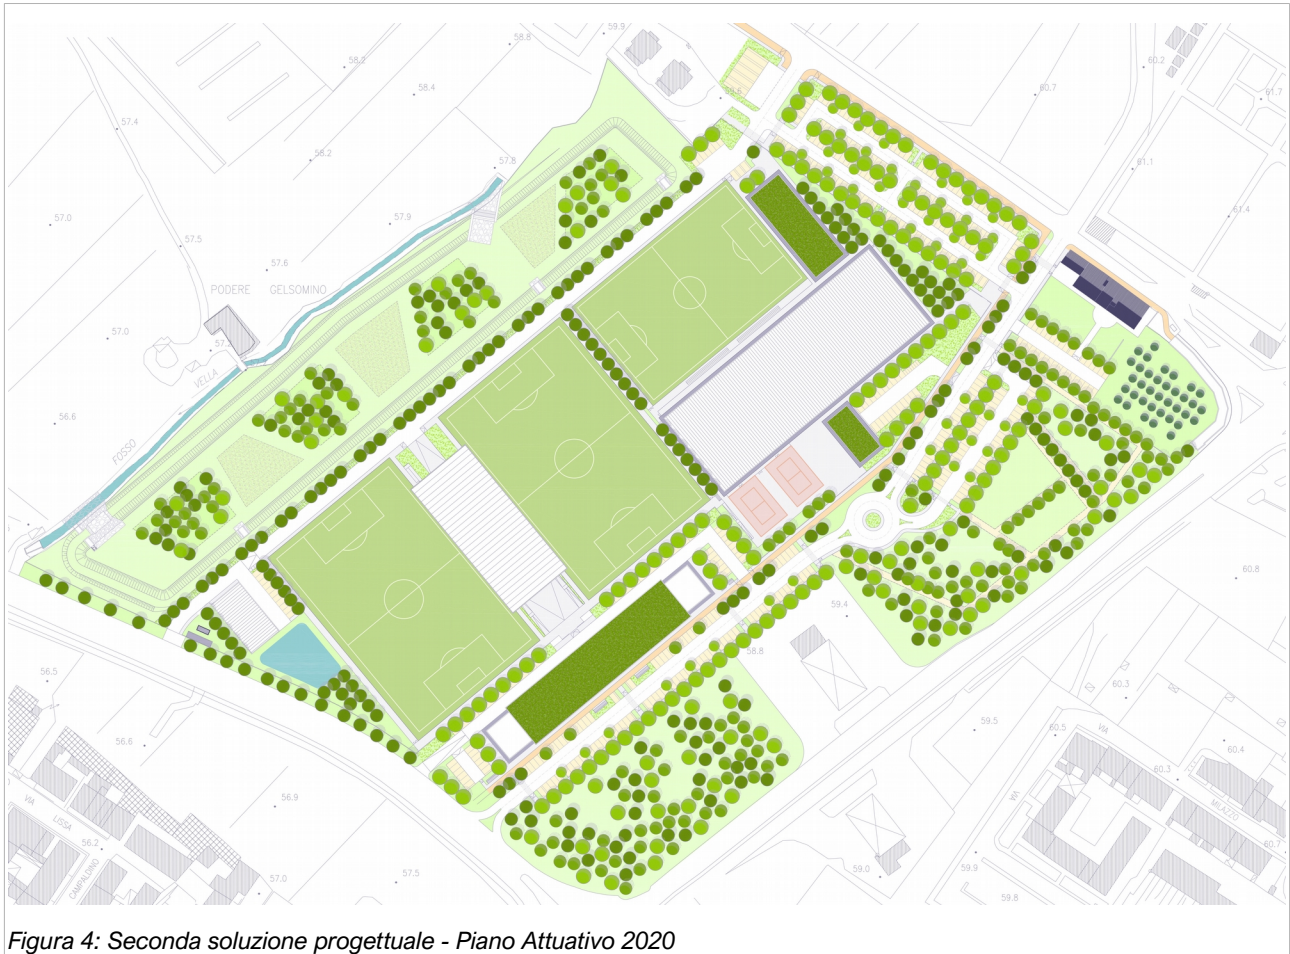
Seconda soluzione progettuale - Piano Attuativo 2020
